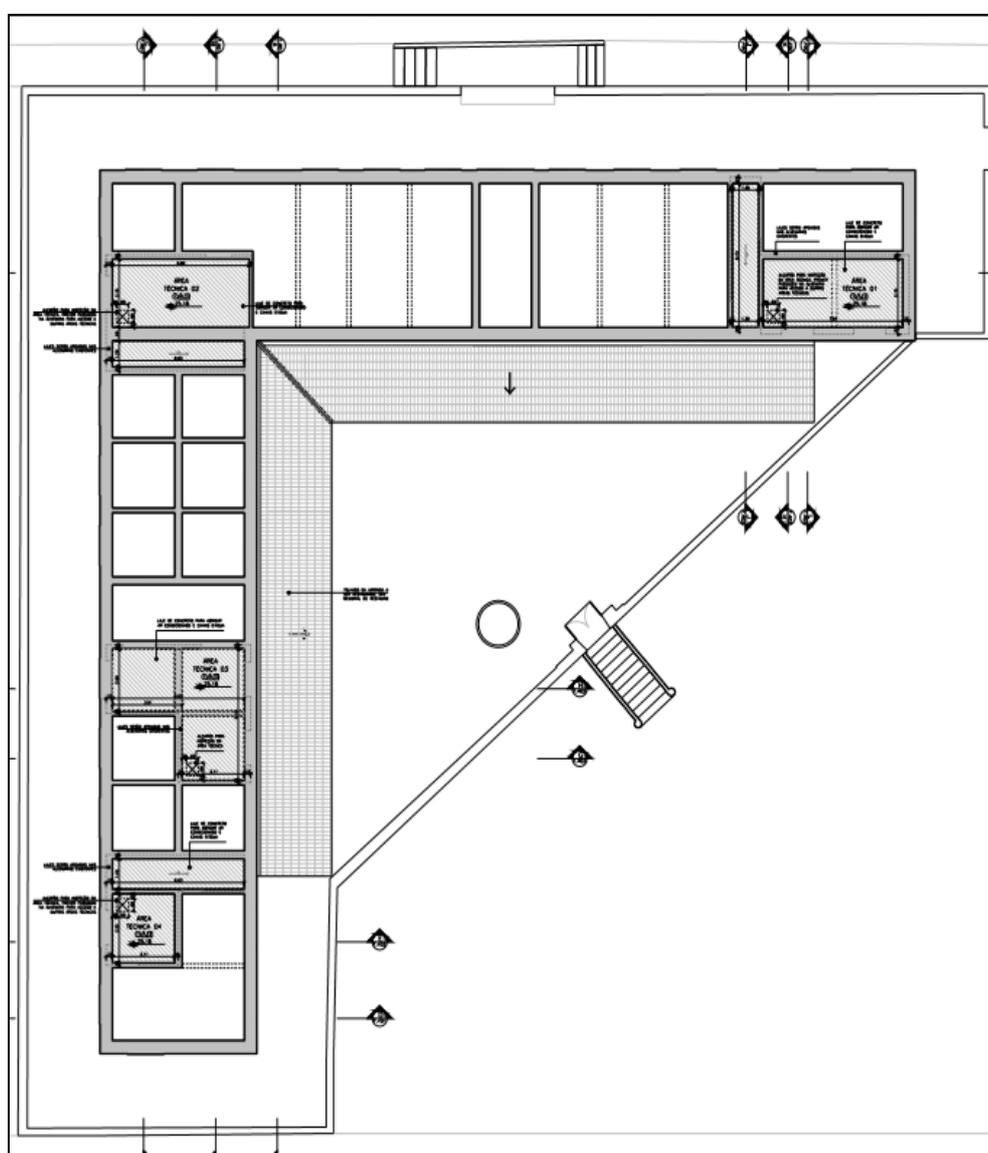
e 9 – Planta Térrea Construção e Demolição e detalhe da planta: em pontilhado, paredes a serem retiradas e vãos a serem abertos.
